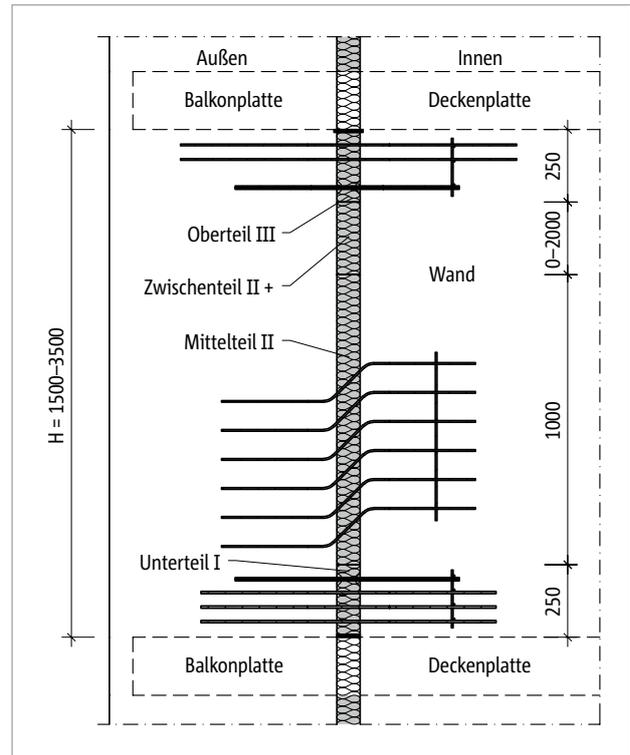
Schöck Isokorb® T Typ W: Balkonkonstruktion mit wärmegeämmten tragenden Wandscheiben
